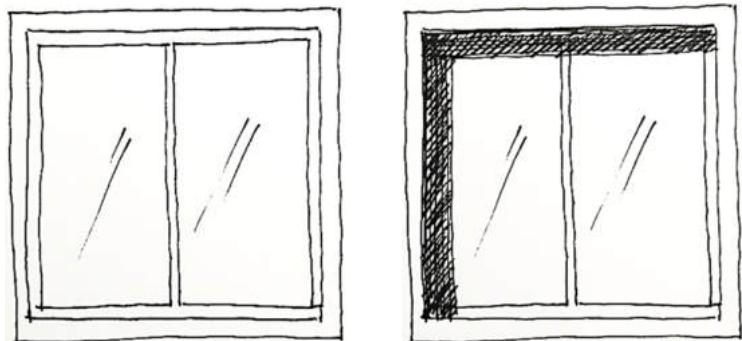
Juego de luces y sombras en las distintas posiciones de la carpintería respecto al plano de fachada. *Fuente: elaboración propia
